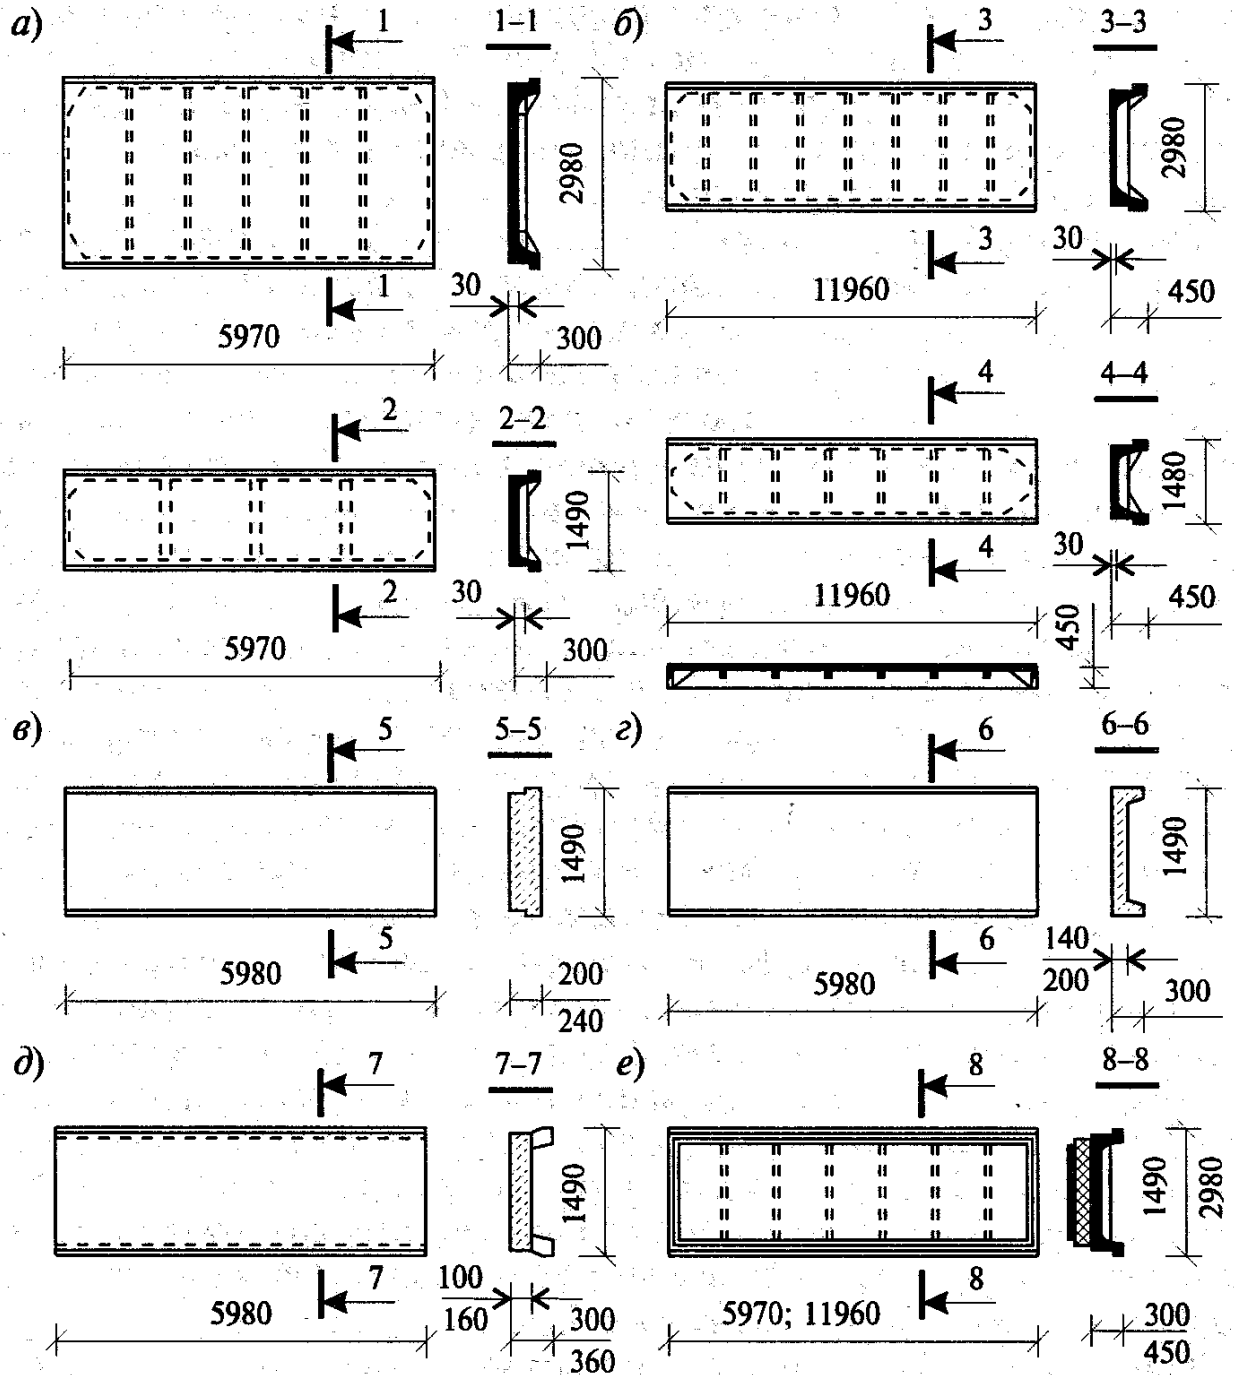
Железобетонные плиты для покрытий без прогонов: а - размером 3х6 и 1,5х6 м; б- то же, 3х12 и 1,5х12 м; в - плоская из ячеистого бетона; г - ребристая из легких бетонов; д - то же, комбинированная из тяжелого и легкого бетонов; е - комплексная панель покрытия
